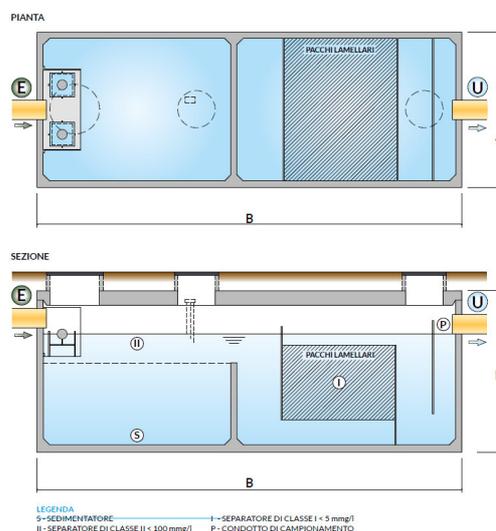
Separatore di idrocarburi tipo - pianta e sezione
